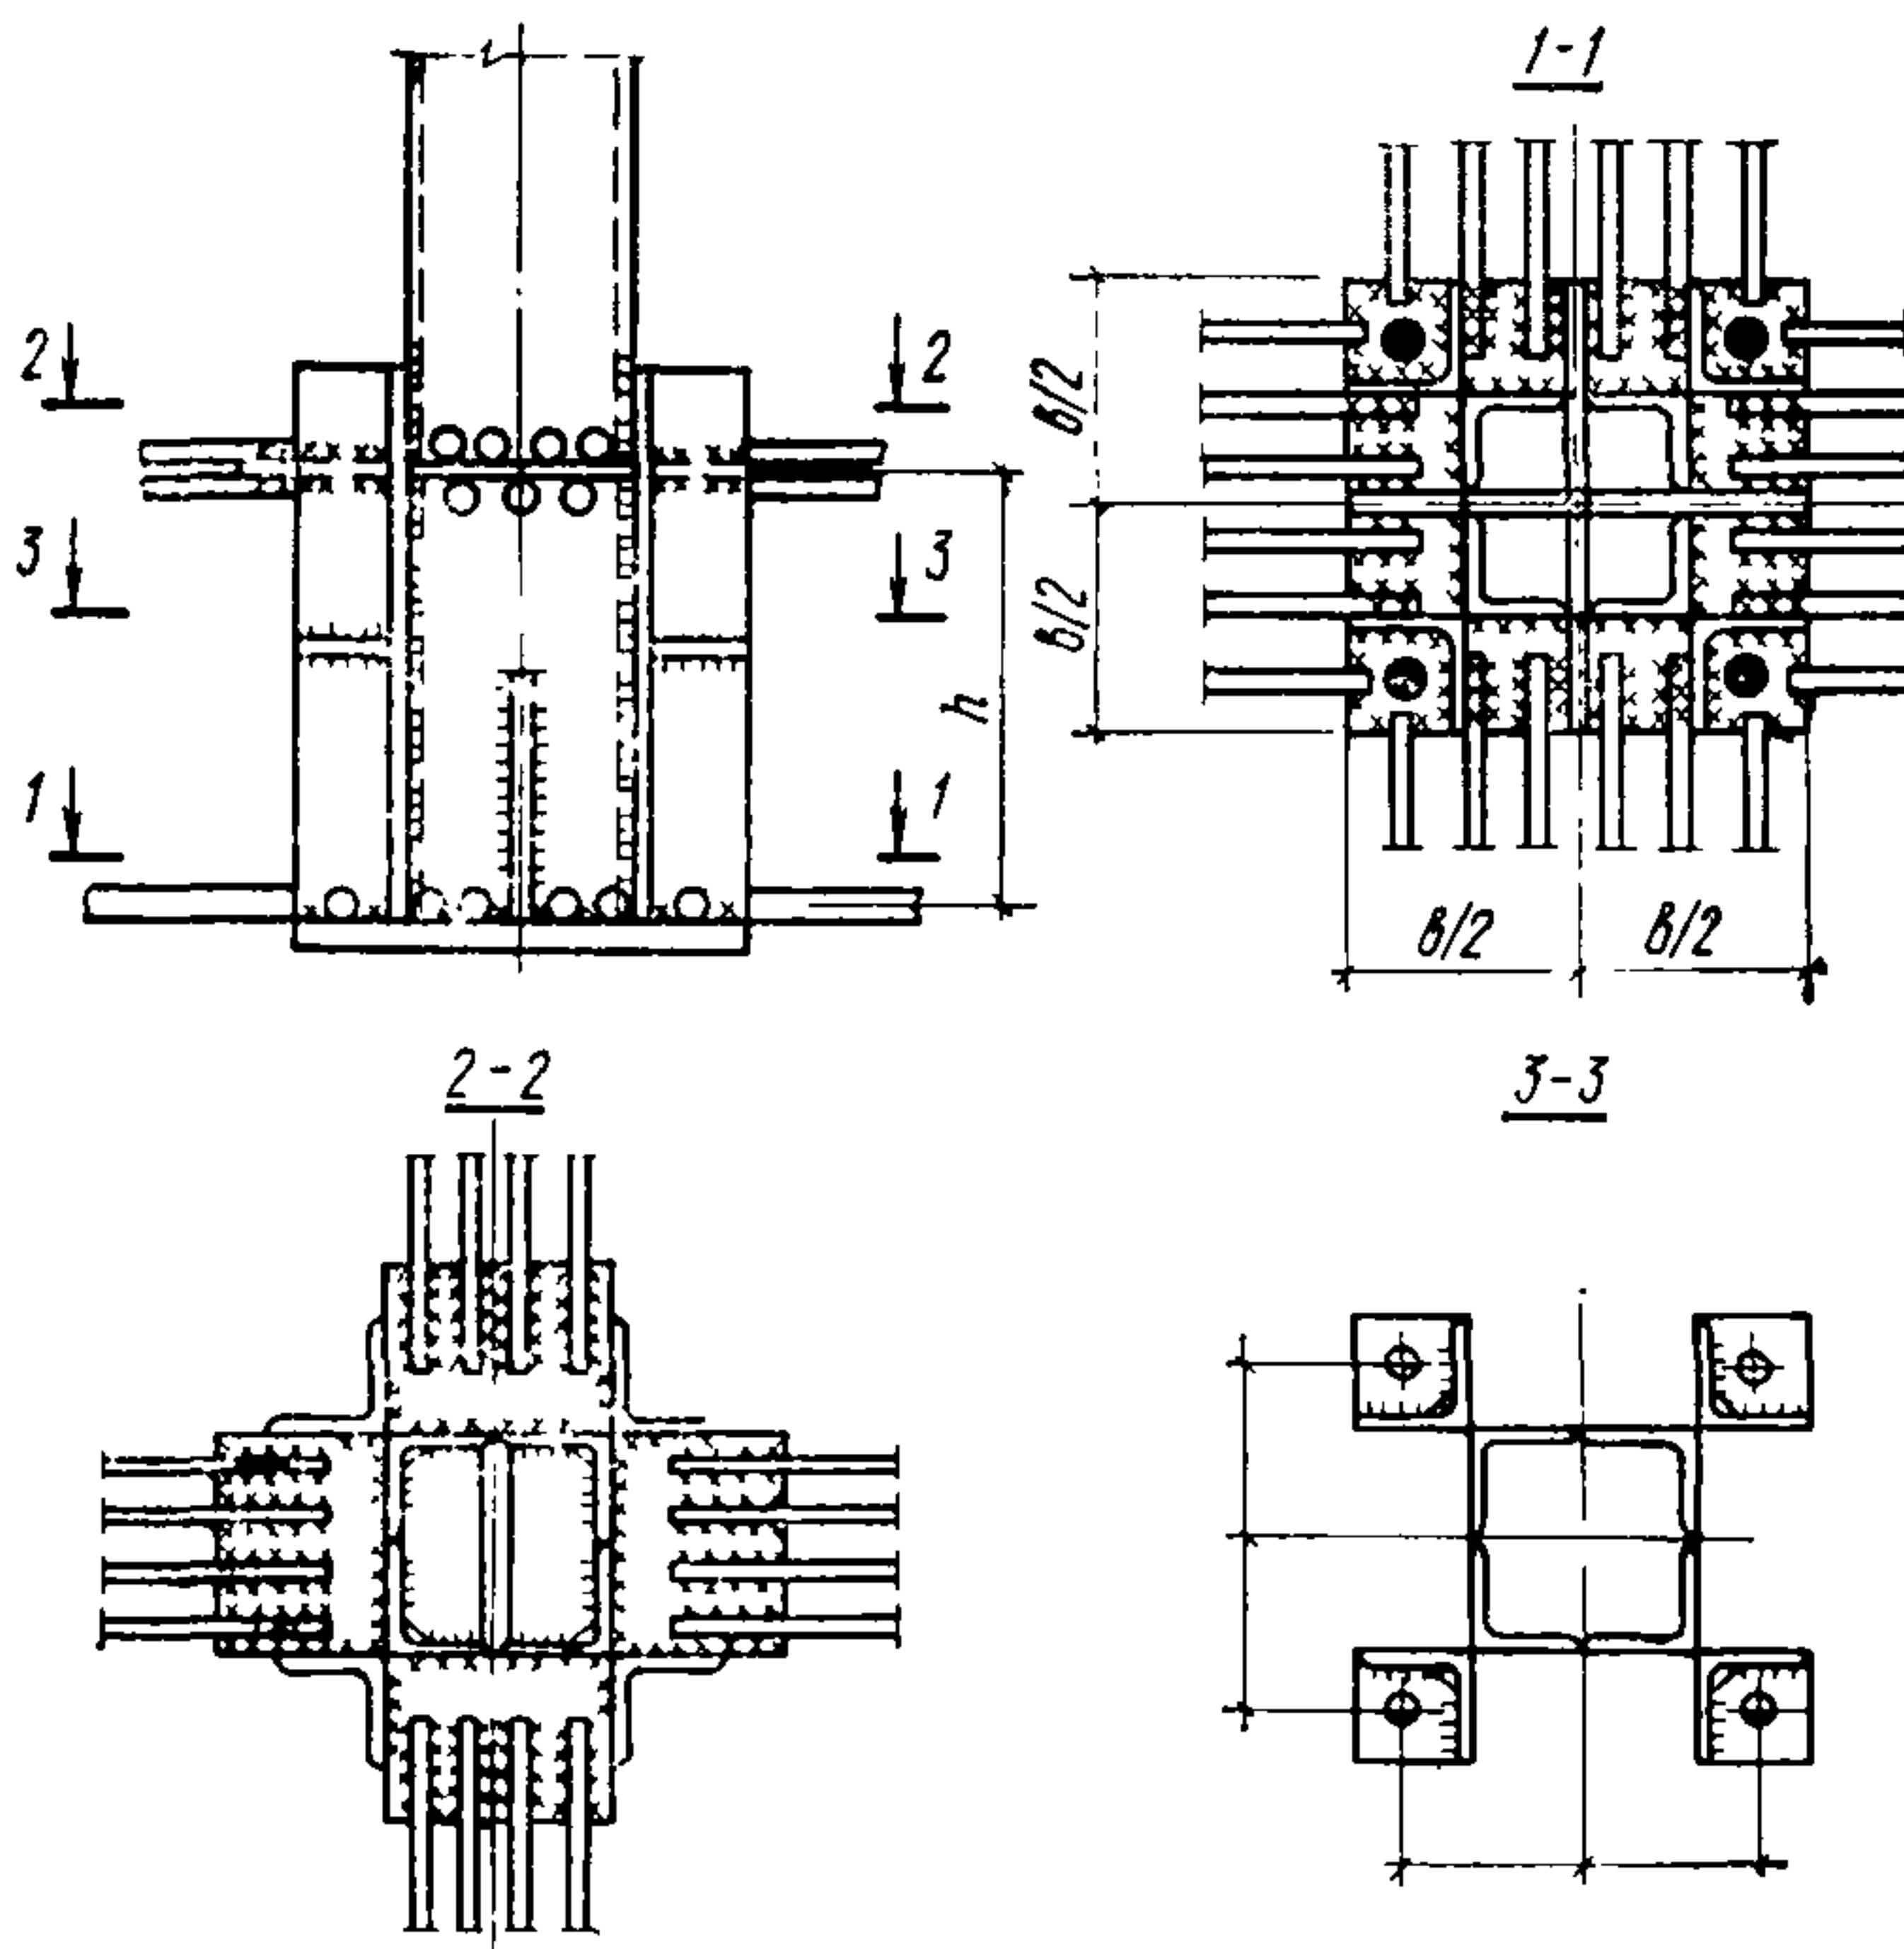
Узел жесткого безбашмачного опирания колонны многоэтажного здания на фундамент
